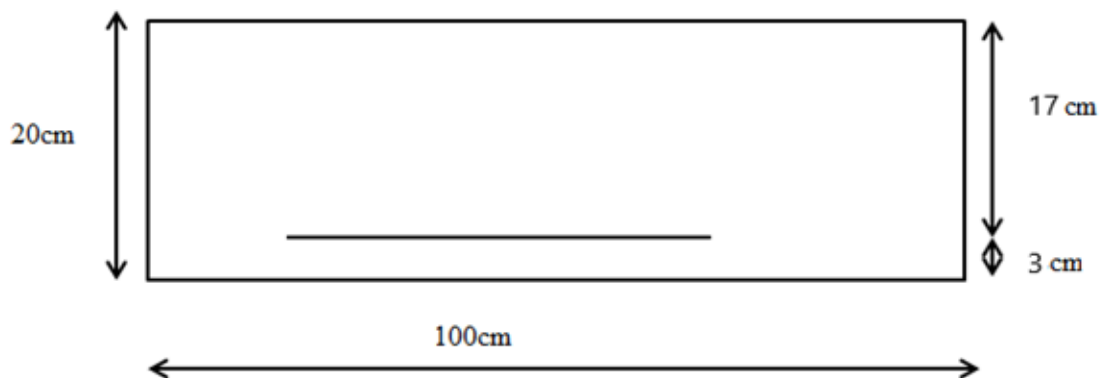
coupe schématique sur la section à prendre dans les calculs
